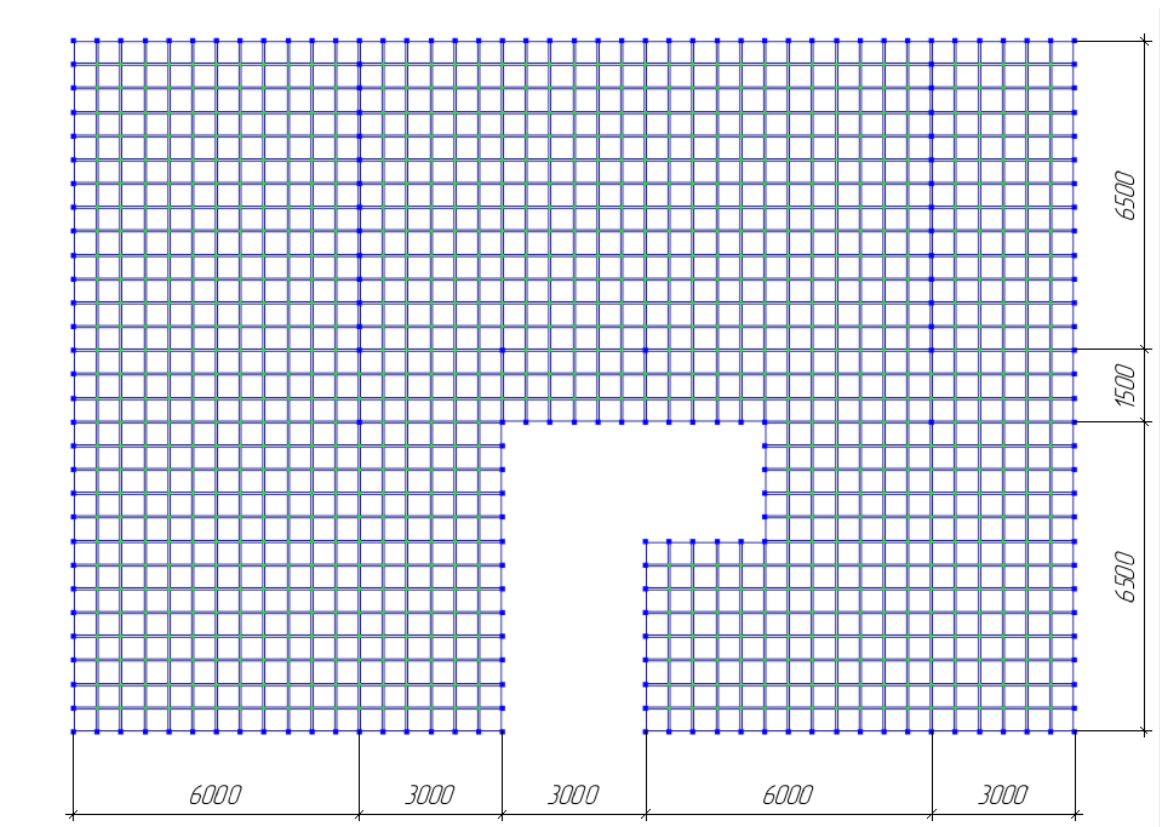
Расчетная схема участка монолитного железобетонного перекрытия в осях 1-6
